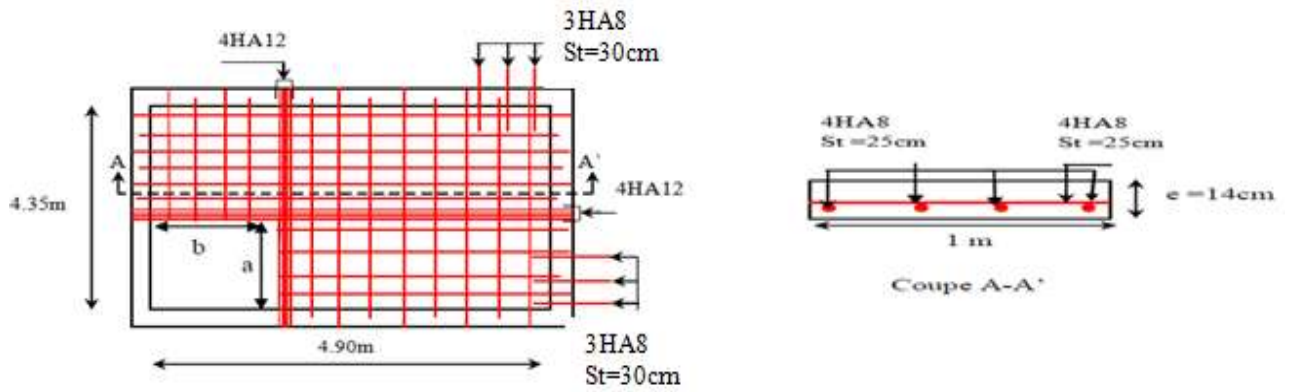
Schéma de ferrailage de la dalle sur quatre appuis D1
